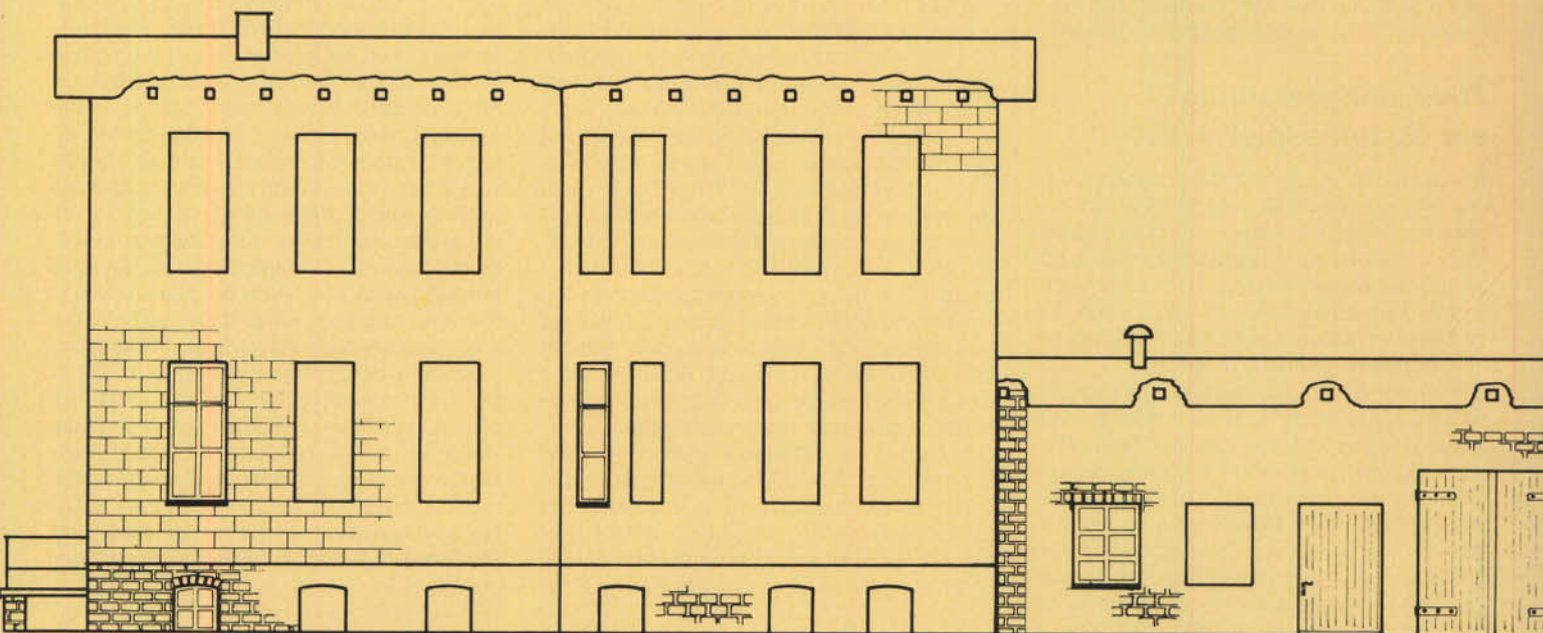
Der Eingang zur Fernmeldemeisterei befindet sich an der Giebelwand. Über eine Treppe gelangt man ins Erdgeschoß. Das gesamte Haus ist unterkellert.
